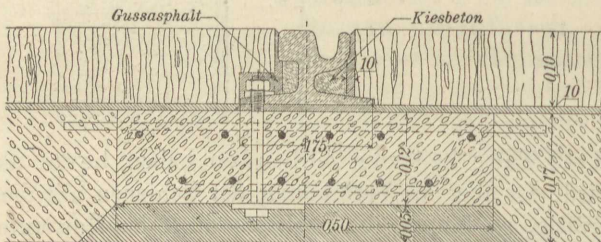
Auflagerung von Straßenbahnschienen in Holzpflaster auf Eisenbetonplatten.
